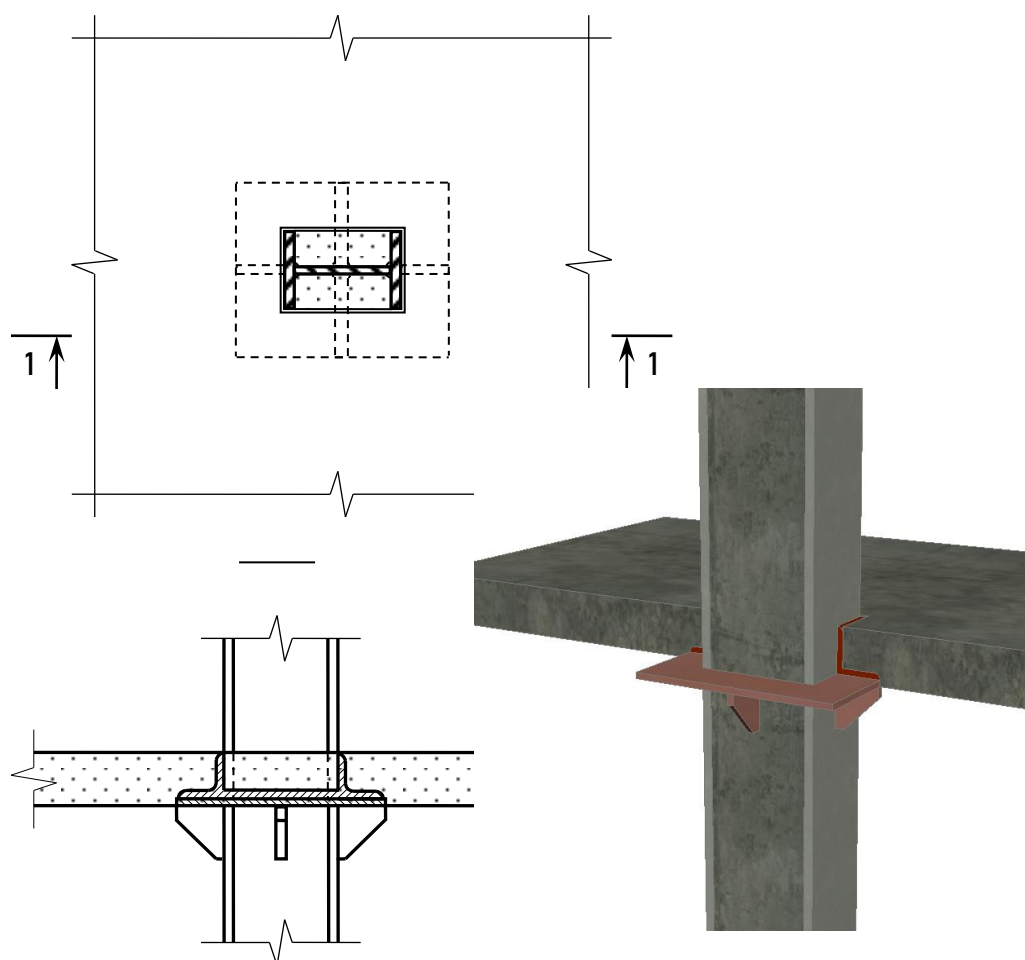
Схема вузла з'єднання надколонної плити сталезалізобетонного безбалкового перекриття з колоною зі складеного двотавра із заповненими бетоном порожнинами
